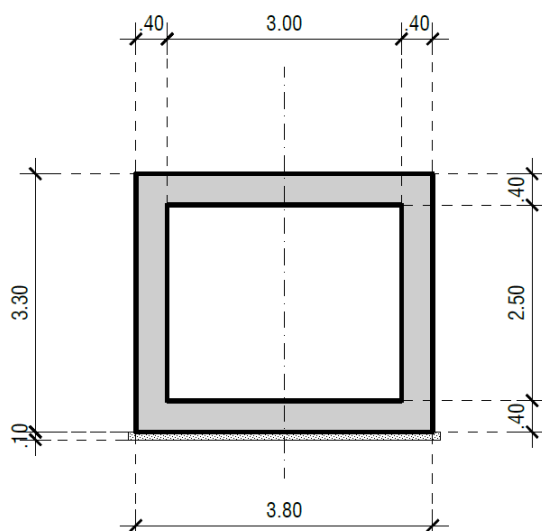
Sezione tipologica attraversamento idraulico scatolare.
